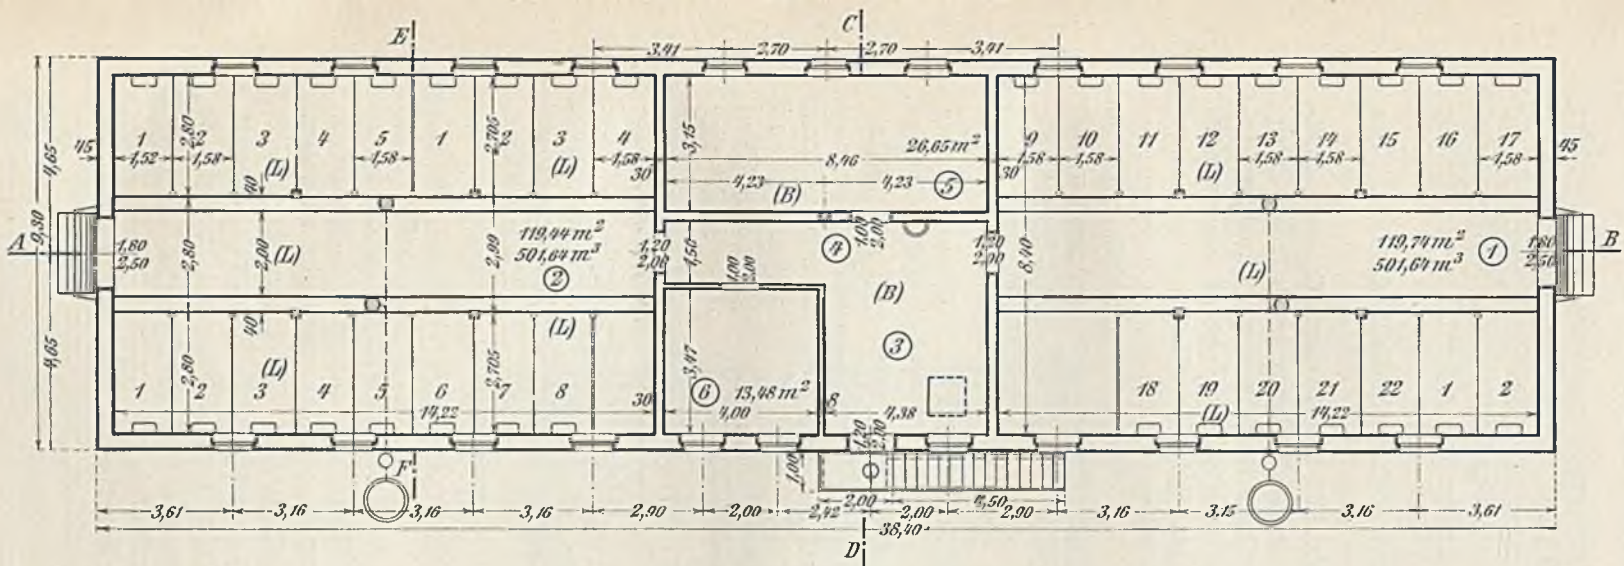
Stallbaracke in Tolmein. Grundriß.
